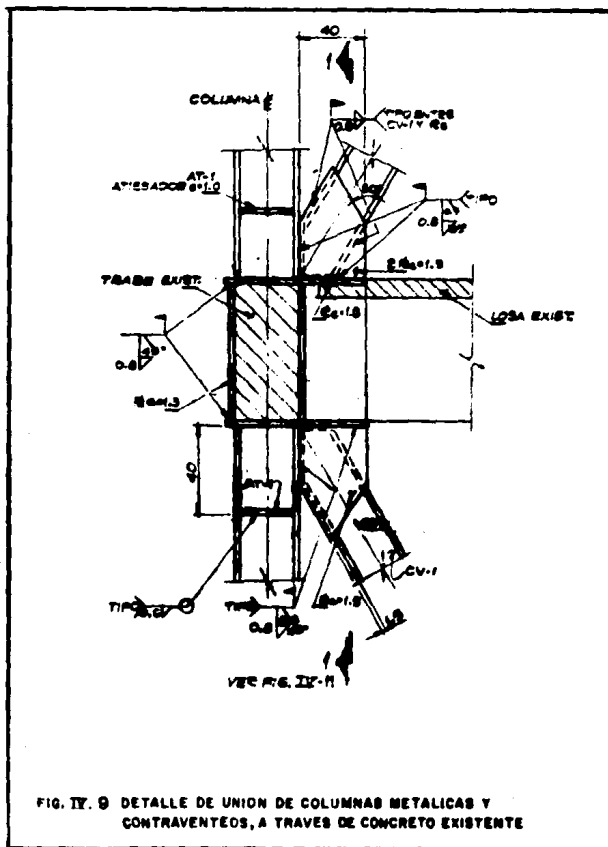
DETALLE DE UNION DE COLUMNAS METALICAS Y CONTRAVANTEOS, A TRAVES DE CONCRETO EXISTENTE
